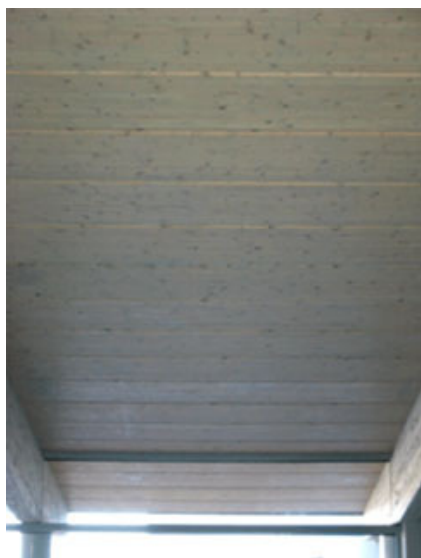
Particolare dell'intradosso piano della copertura Wood Beton Evoluzione.
